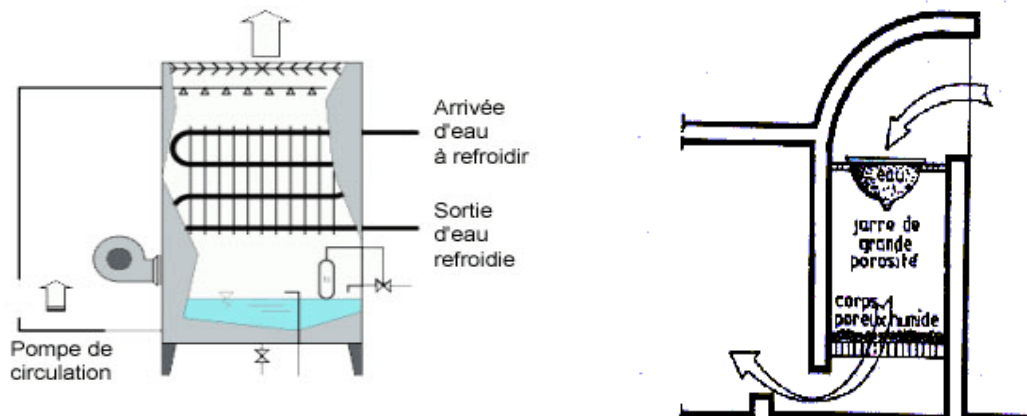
Dispositifs de refroidissement évaporatif a droite système traditionnel, a gauche système de rafraîchissement moderne en passant l'air chaud sur des conduites d'air refroidie
